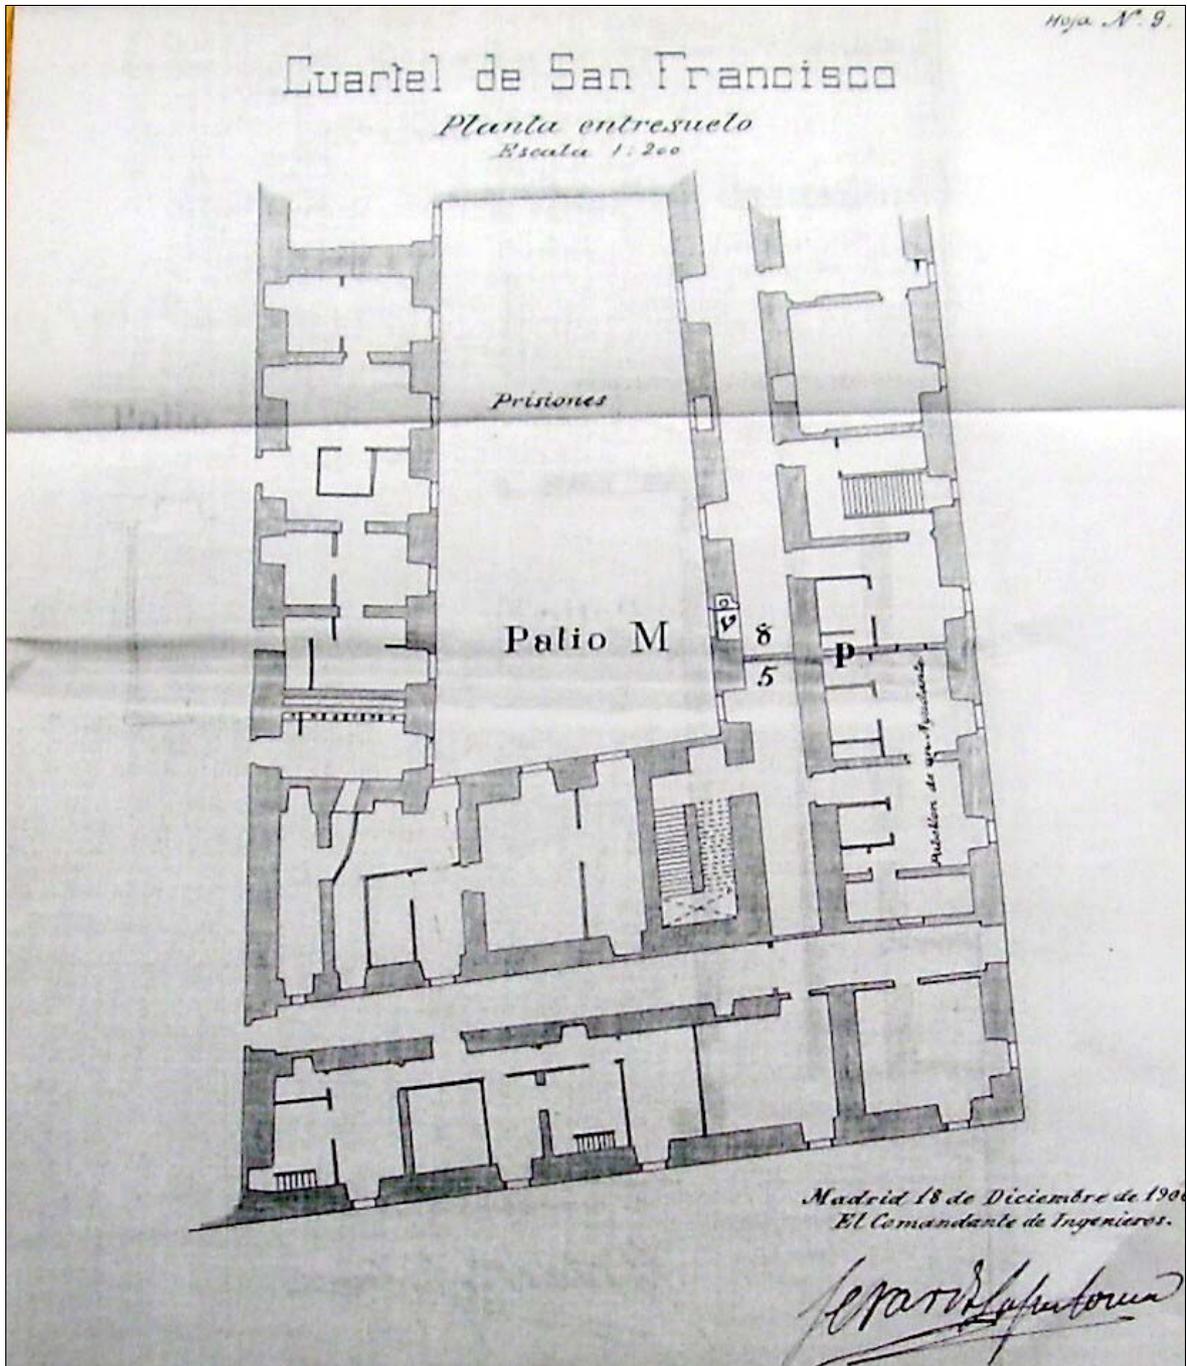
Cuartel de San Francisco. Levantamiento planimétrico de planta de entresuelo de la zona de Prisiones Militares.. Escala original, 1:200. Archivo General Militar, Sección 3ª., división 3ª., leg. 580.
